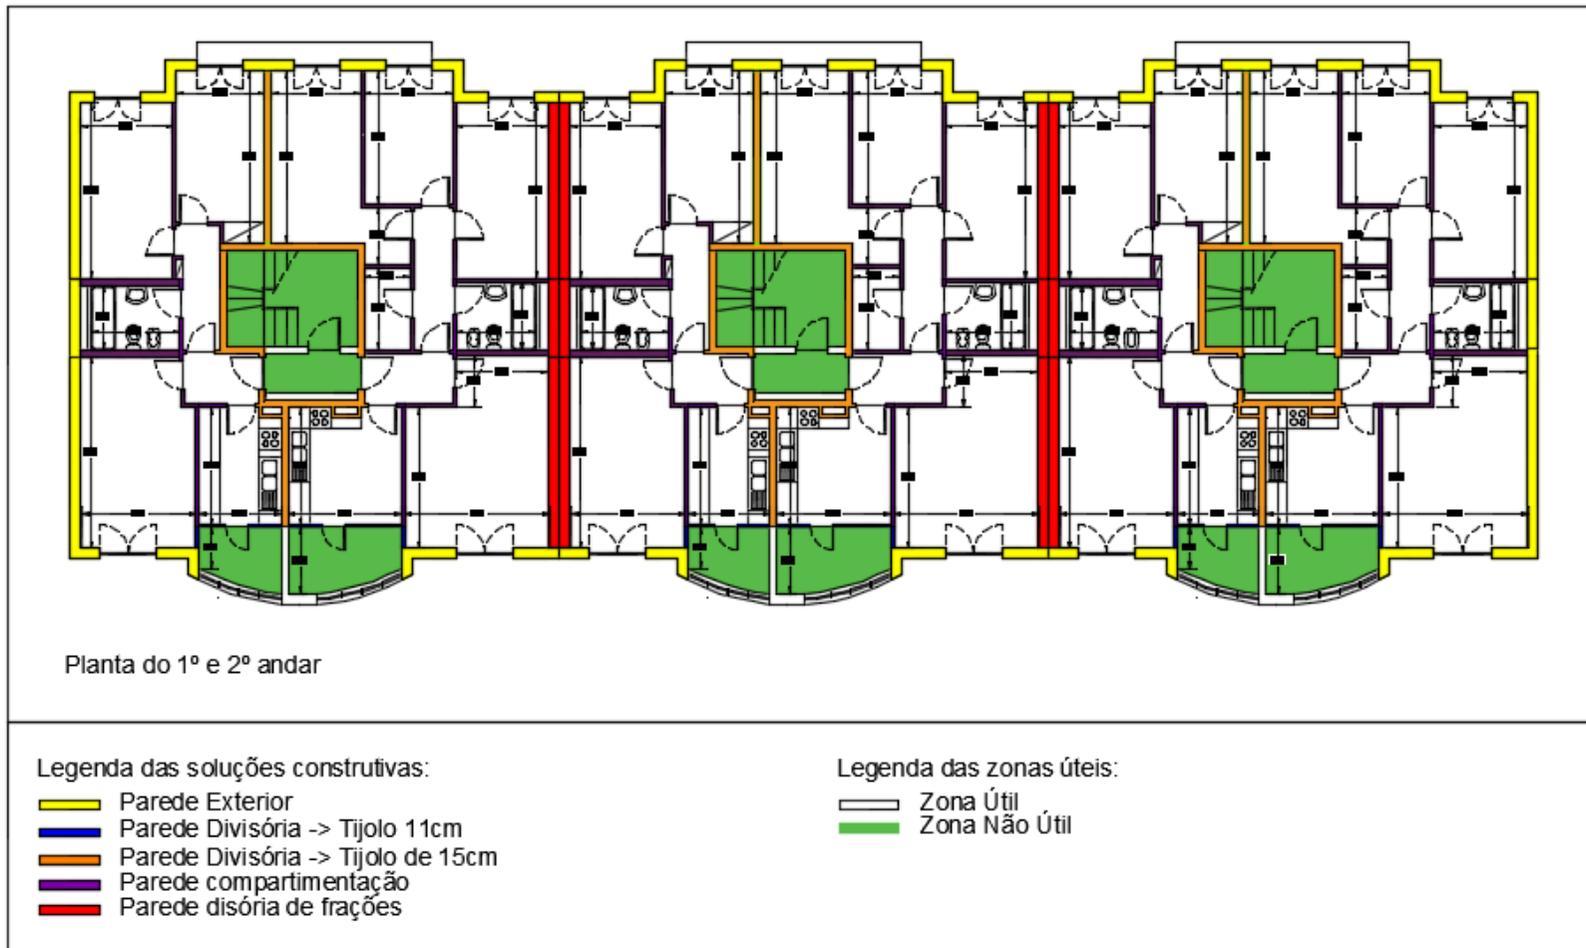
Soluções construtivas – Planta do 1º e 2º andar
